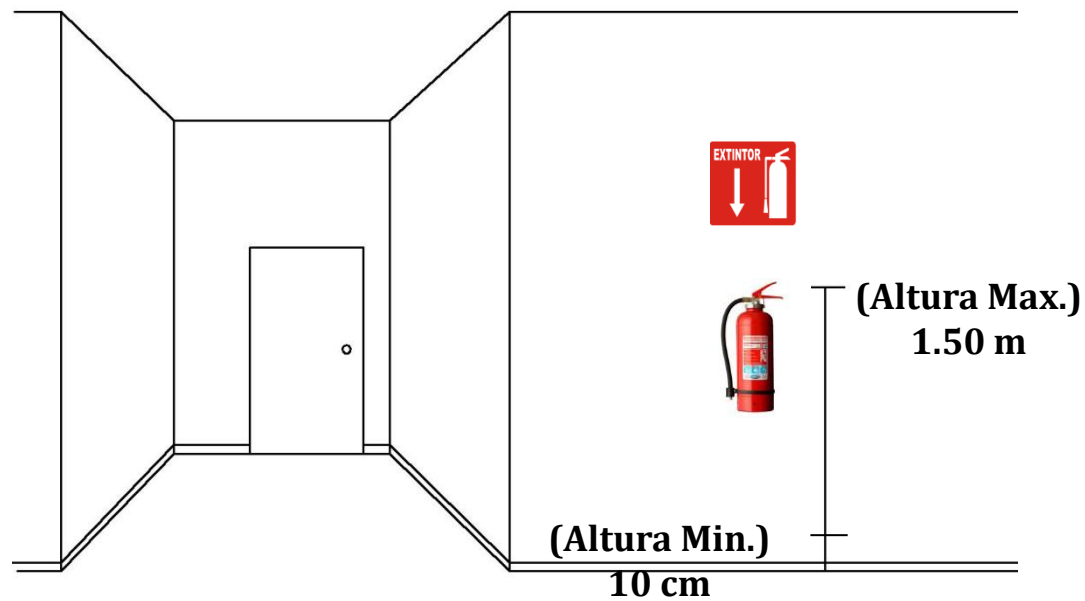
ESQUEMA DE COLOCACIÓN DE EXTINTORES
